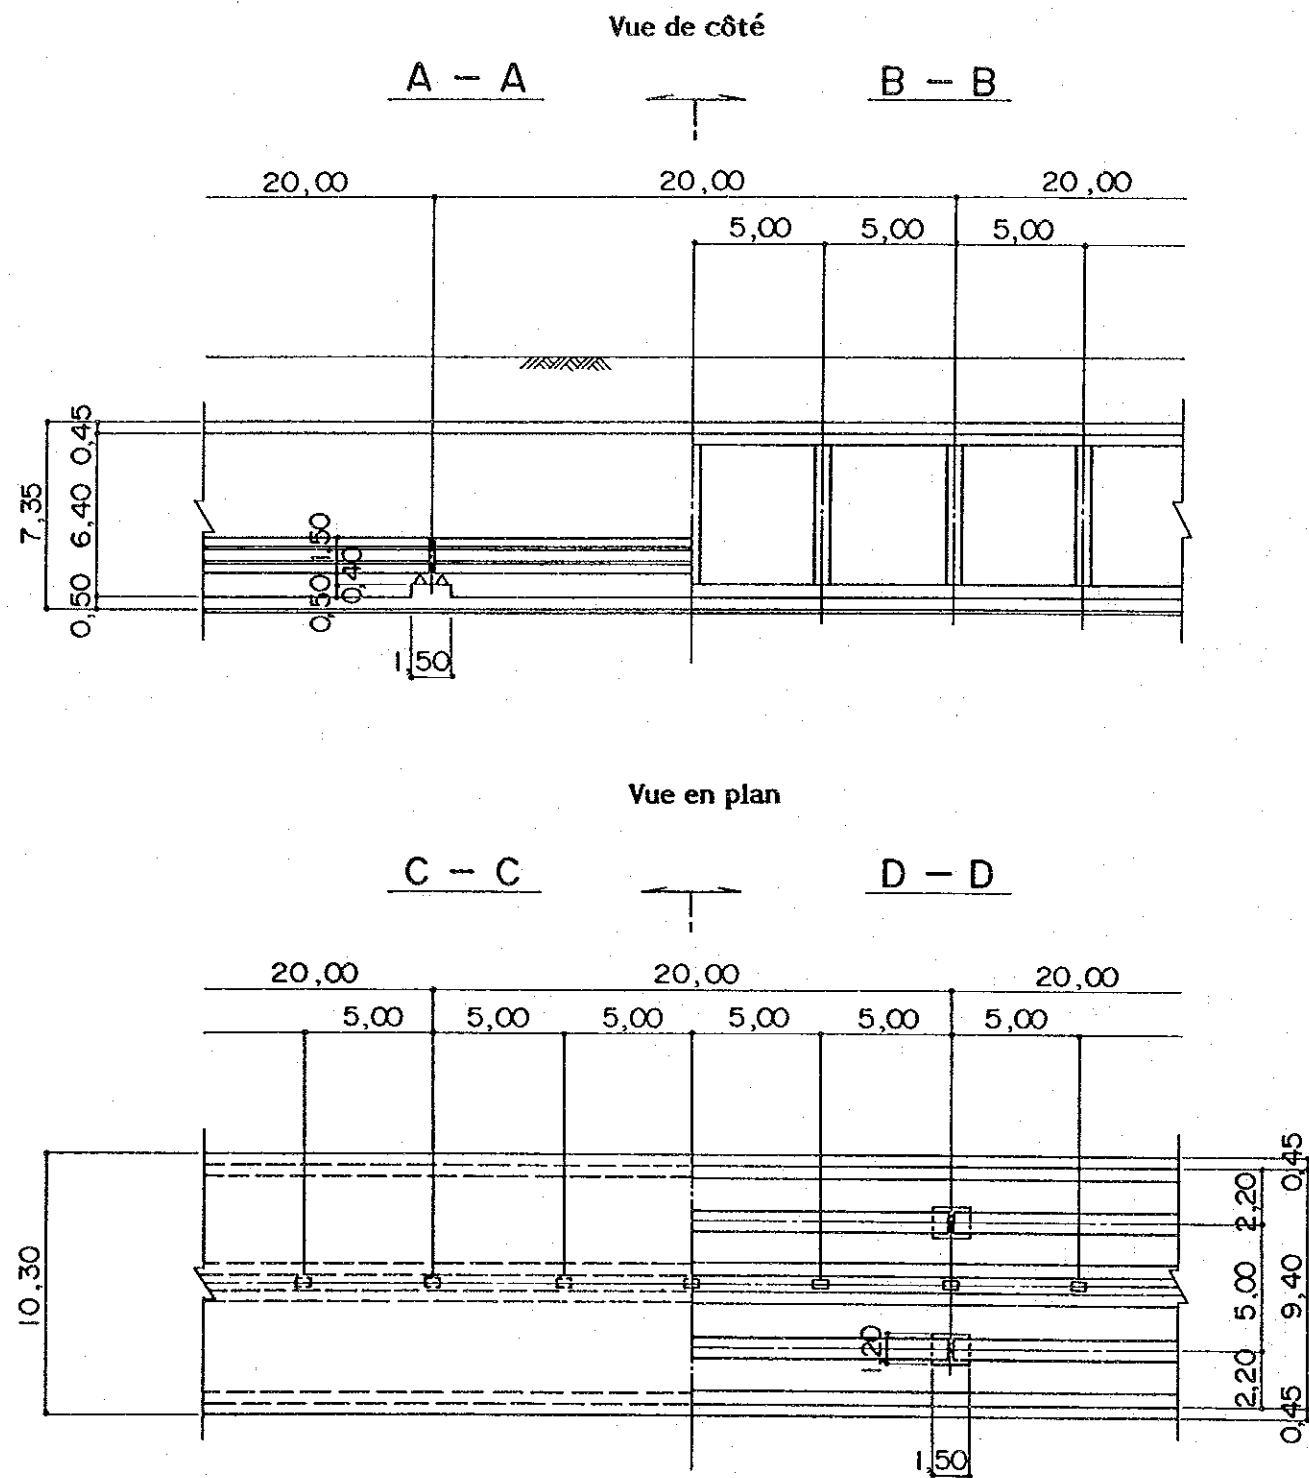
Ouvrage souterrain standard (monorail sur poutre)
